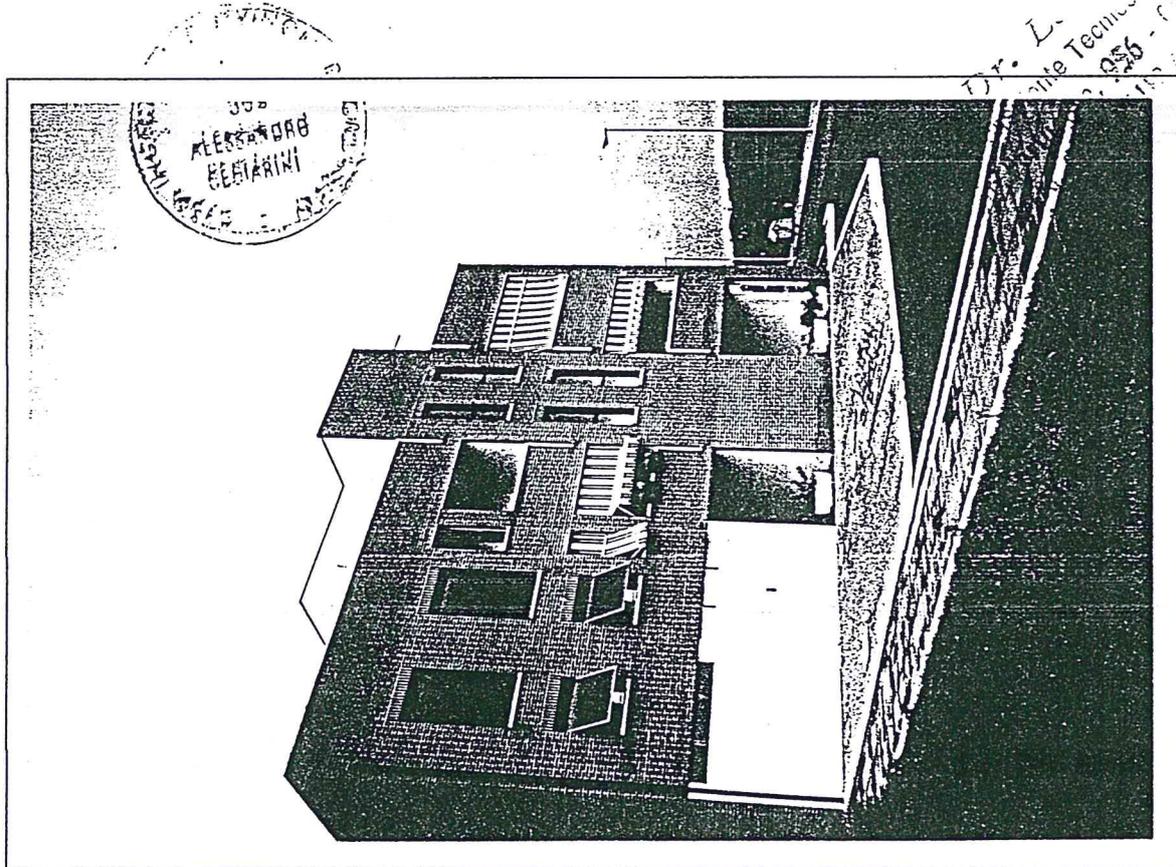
Prospetto Ovest con in evidenza lo spazio di manovra con colorazione chiara.
